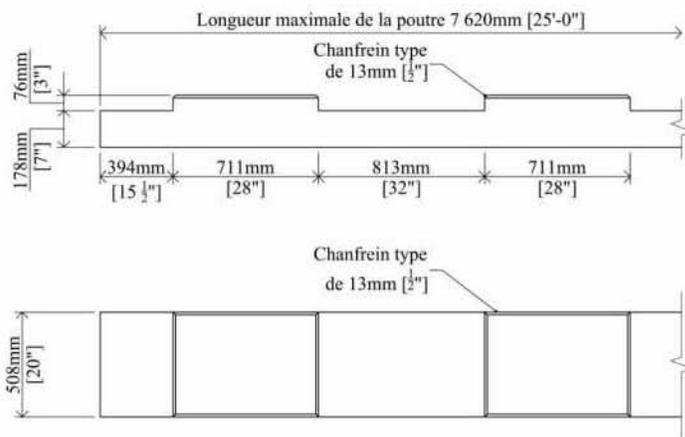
(iii) : Poutre de fondation reposant sur le sol pour stèles plates et stèles commandées spécialement – poutre enterrée, stèle surélevée au-dessus du gazon.
